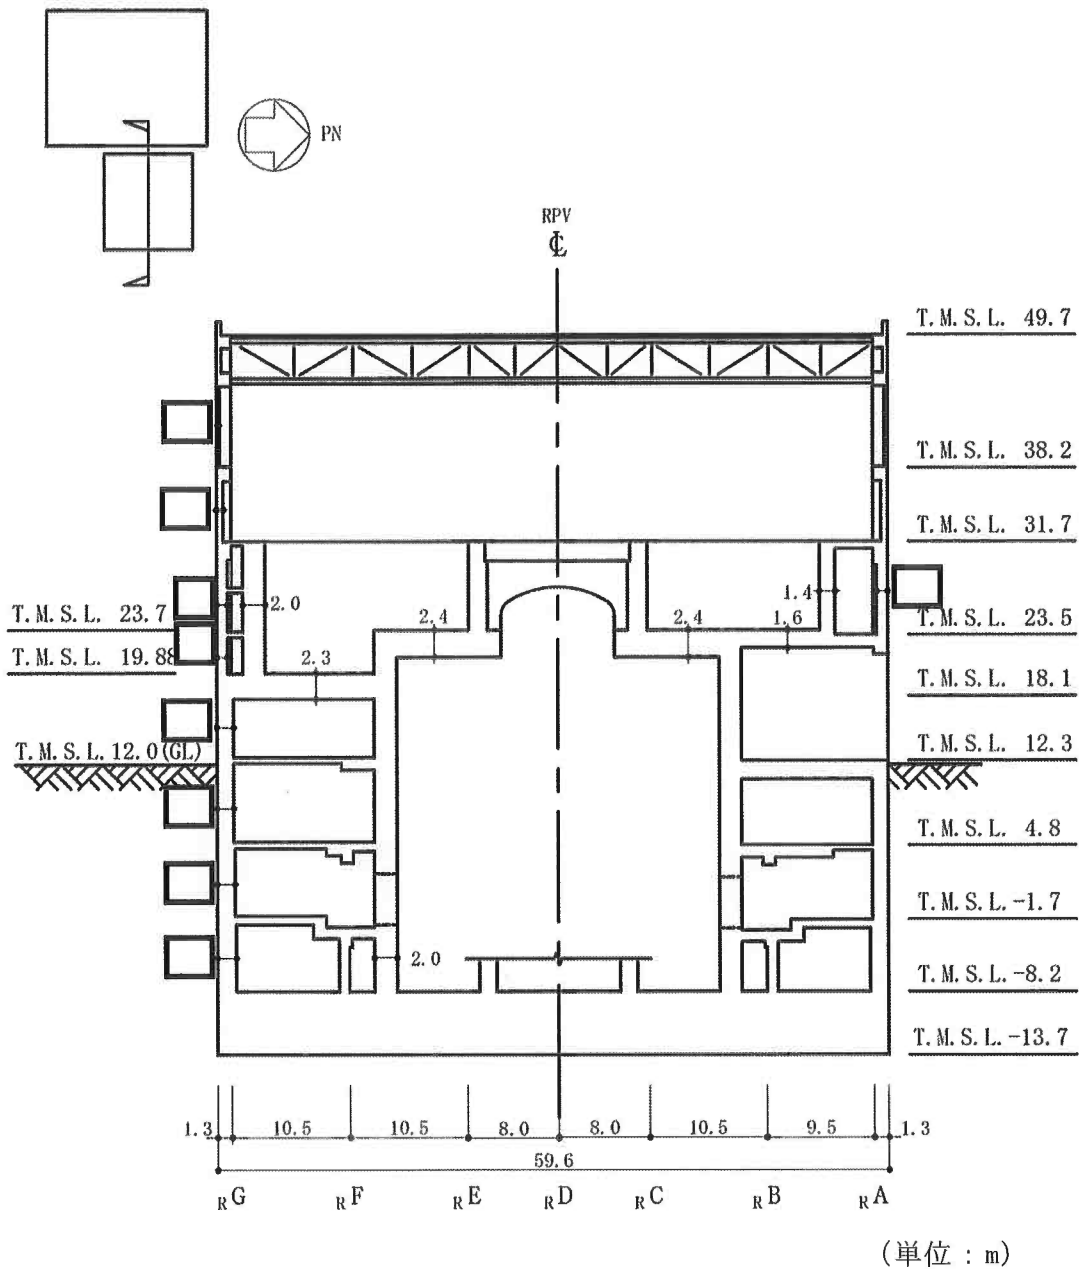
原子炉建屋の概略断面図 (EW 方向) (2/2)
